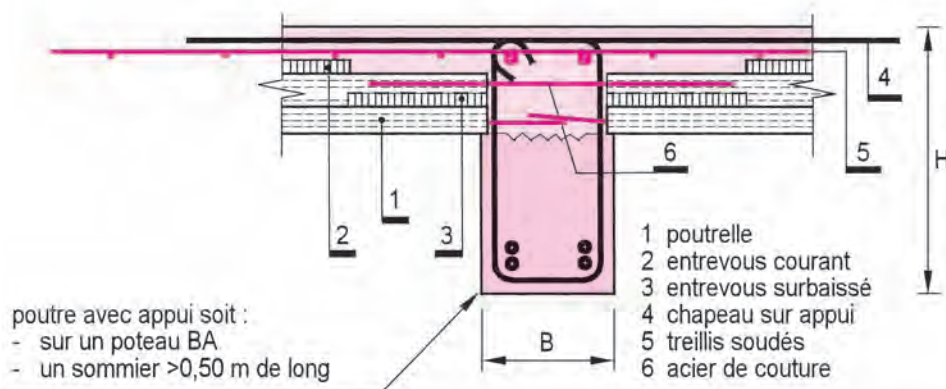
Coupe sur poutre en T avec retombée sous plancher
